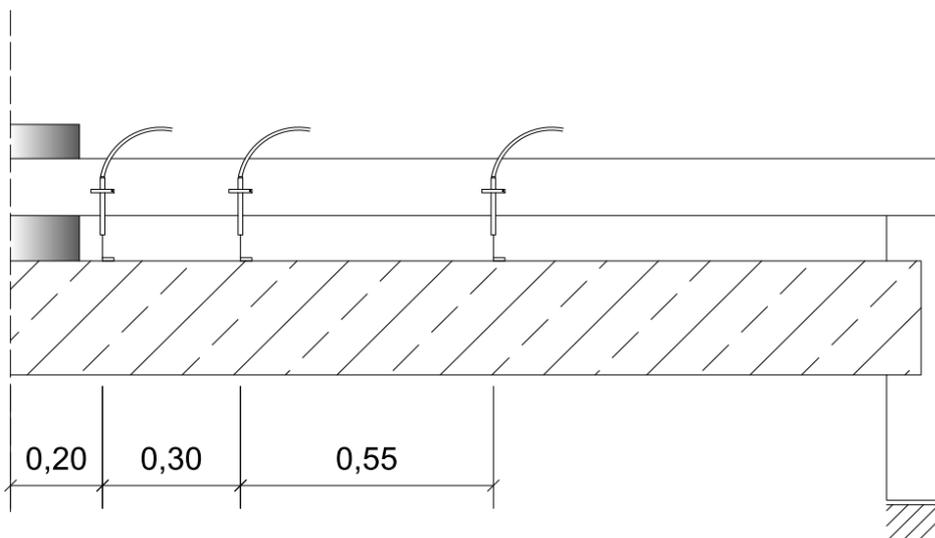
Befestigung der Wegaufnehmer: Seitenansicht
